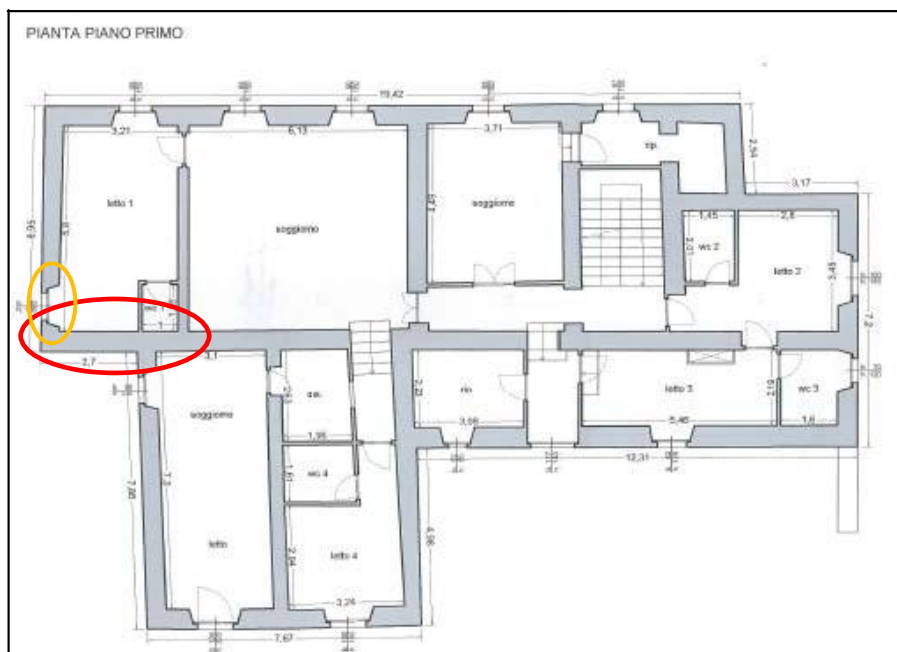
Figura C - Individuazione del maschio murario interessato dalla lesione oggetto di perizia (colore rosso) e dell'apertura causa di indebolimento (colore arancione) – Piano primo
